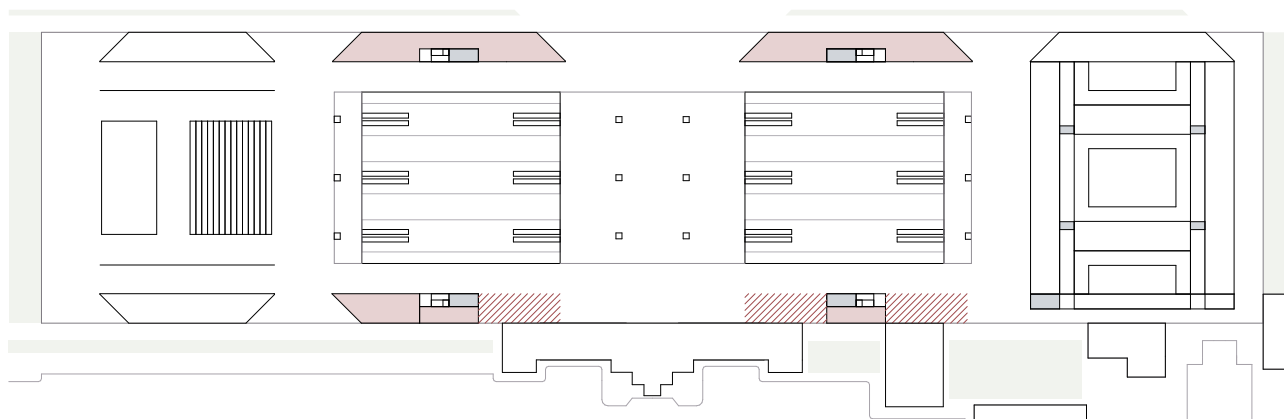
| Restauração (Piso Térreo) // Restauração Instalações Sanitárias
